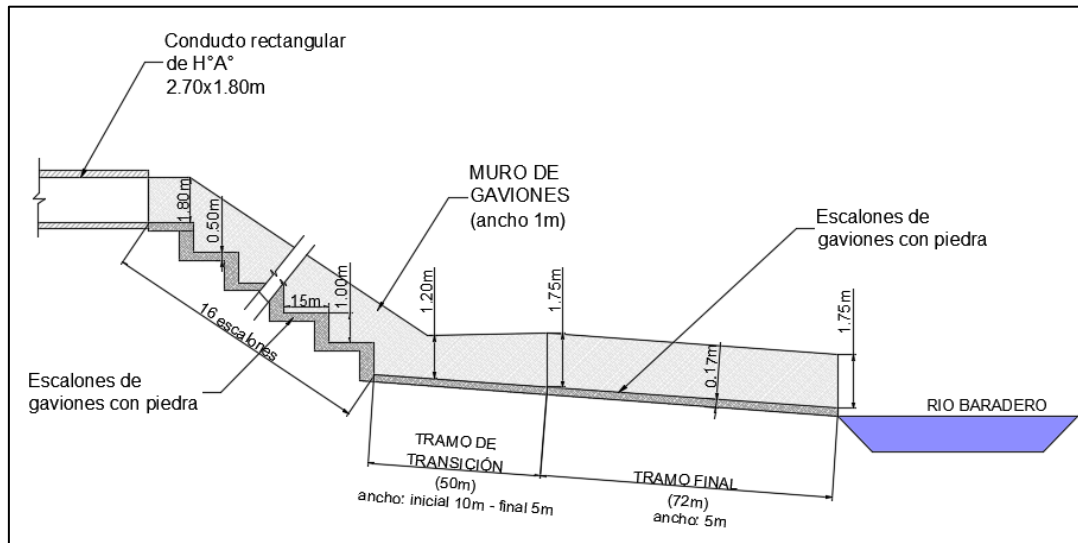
Perfil completo desde zanjón hasta el río. Fuente propia
